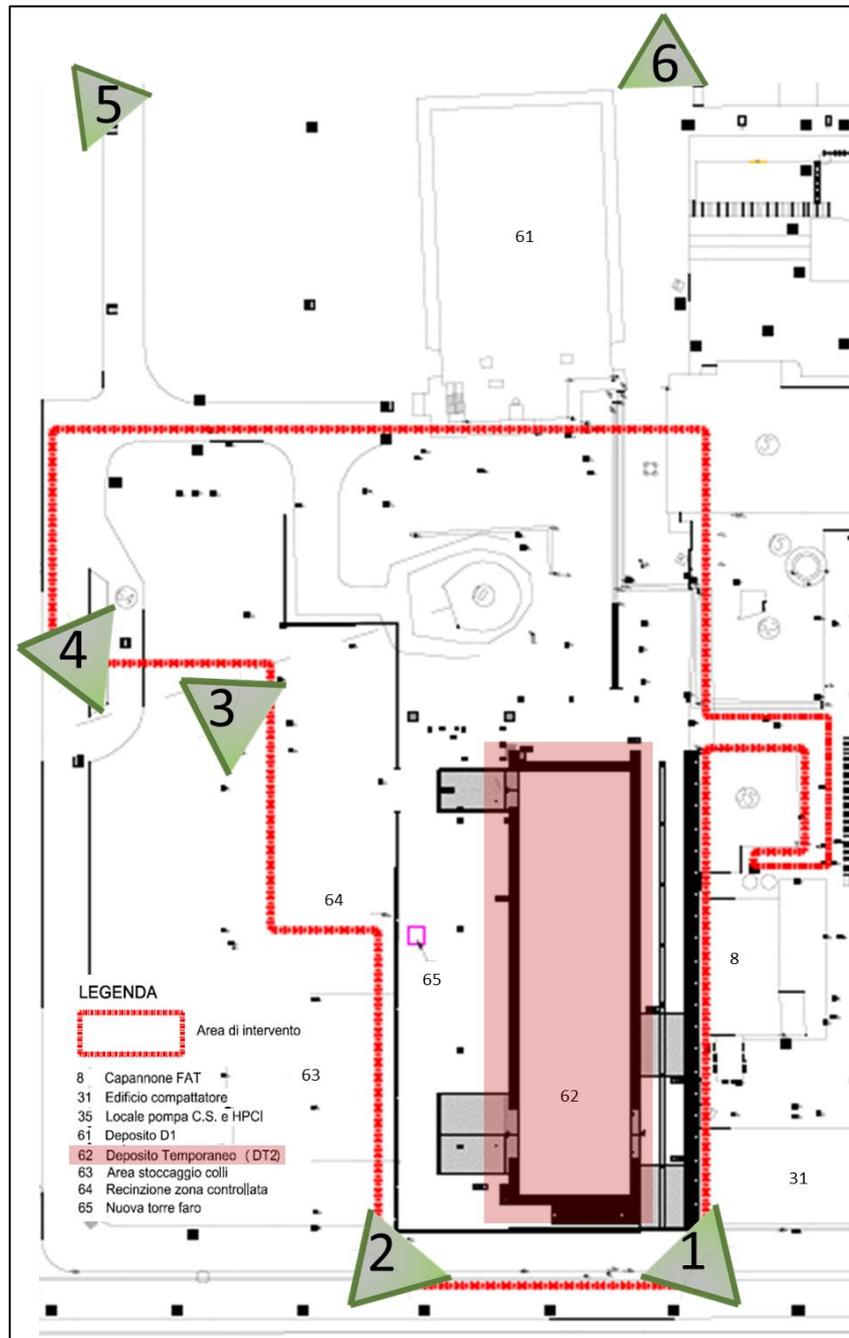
Stato di fatto – planimetria dei punti di vista
